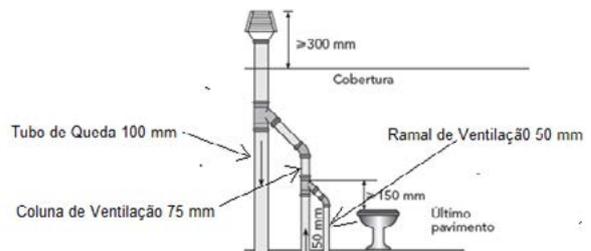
Detalhe da ventilação primária (ligação da ventilação no último pavimento)
